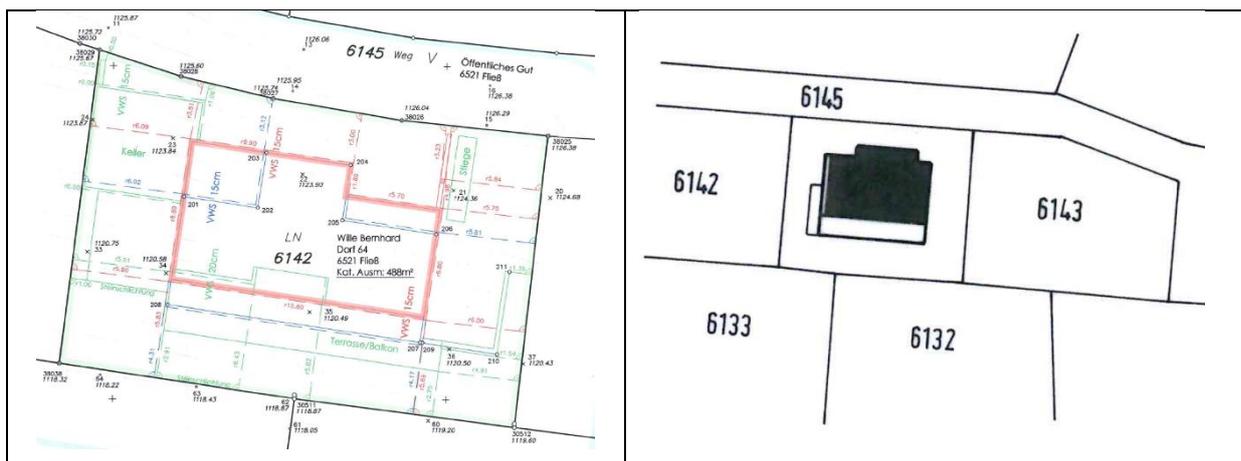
Lagepläne der Wohngebäude auf den Gpn. 6142 (links – seitens Vermessungsbüro Lechleitner & Stürz) und 6534 (rechts – seitens Planungsbüro DDipl.-Ing. Walter H. Schuler) (ohne Maßstab)
